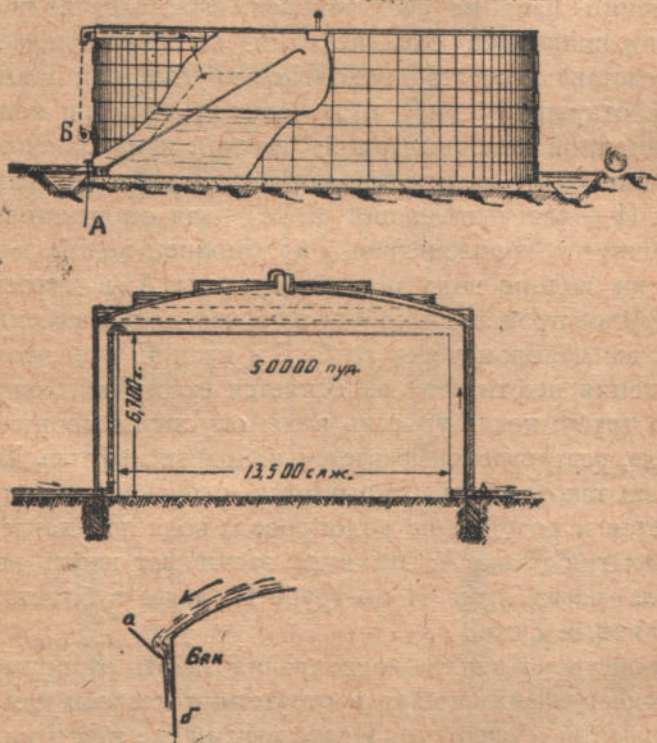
Устройство подвижной трубы для выпуска нефти из металлического бака.
